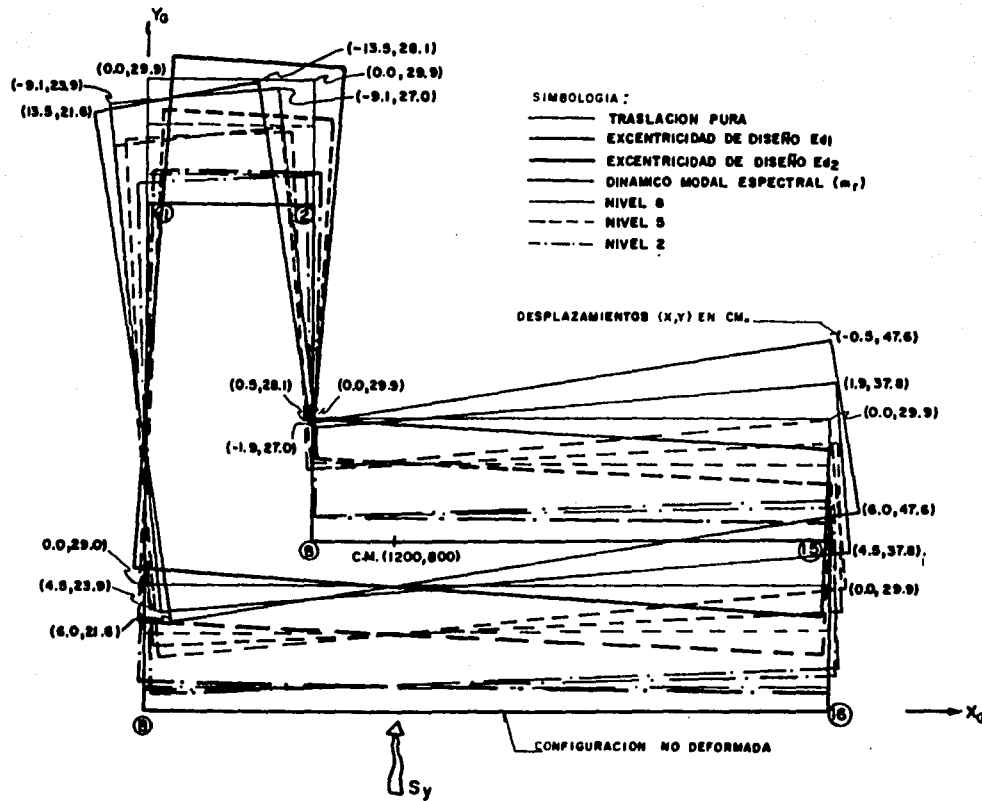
DESPLAZAMIENTOS HORIZONTALES MAXIMOS DE LA ESTRUCTURA EN PLANTA. NIVELES 2,5y8. SISMO EN LA DIRECCION Y. EDIFICIO CASO B.
